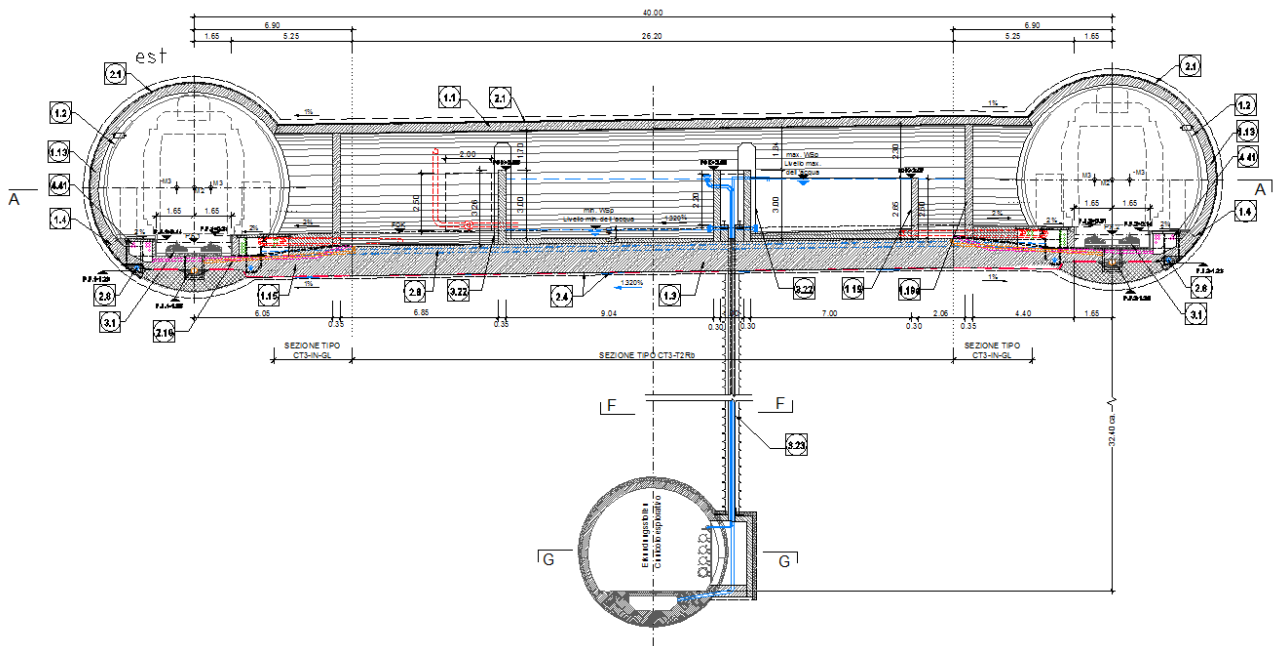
Querstellen Typ 3 (BP 51/2) - Grundriss und Längsschnitt [30].
